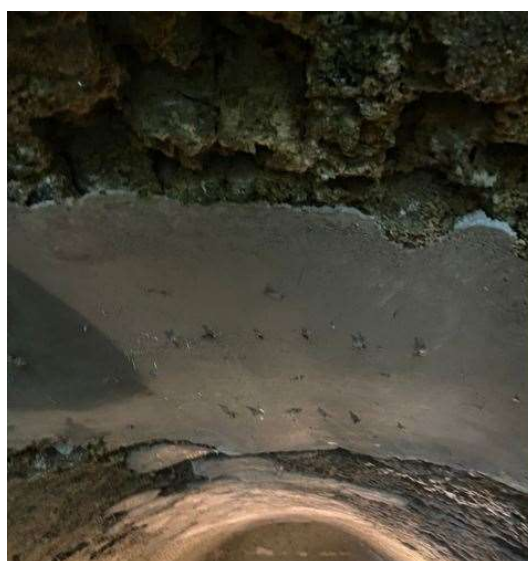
Fechamento da chaminé seccionada na região do teto da fornalha com concreto em substituição aos tijolos refratários.
